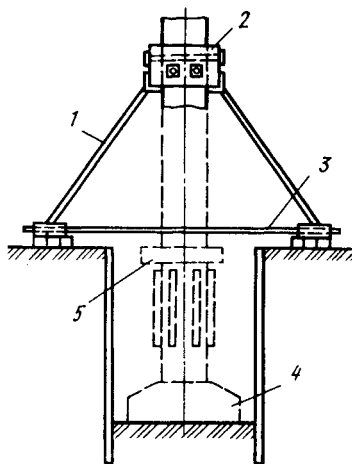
Подводка фундаментов под колонны на глубоких отметках с помощью приспособления «ножницы»: 1 — подкос; 2 — воротник; 3 — стальной анкер; 4 — новый фундамент; 5 — старый фундамент
